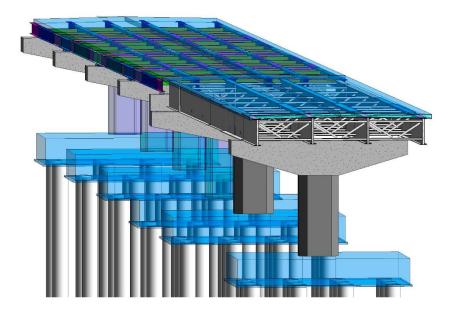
Identificar la categoría de pilares, vigas y losa. (fuente: elaboración propia)
